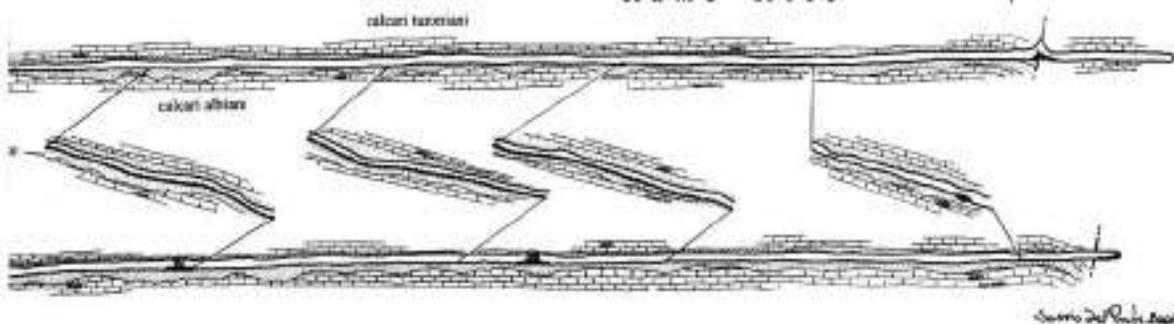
planimetria e sezione longitudinale della miniera di Fontana Tasso (grafica S. Del Prete).
